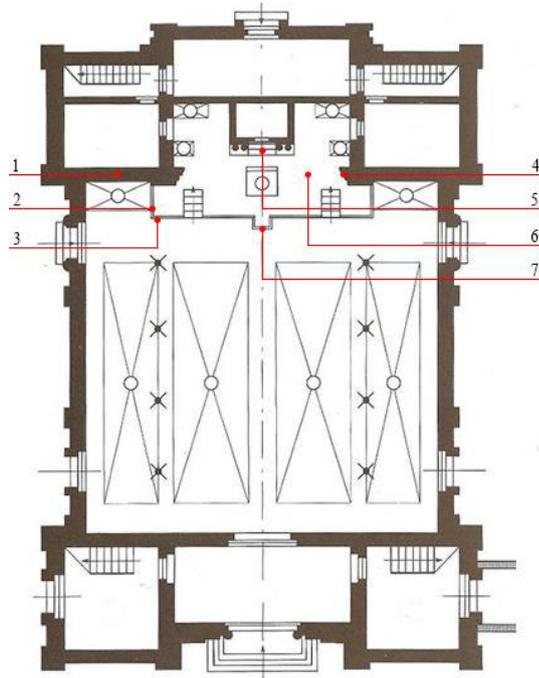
, Grundriss, Unterschiede zum Bild
